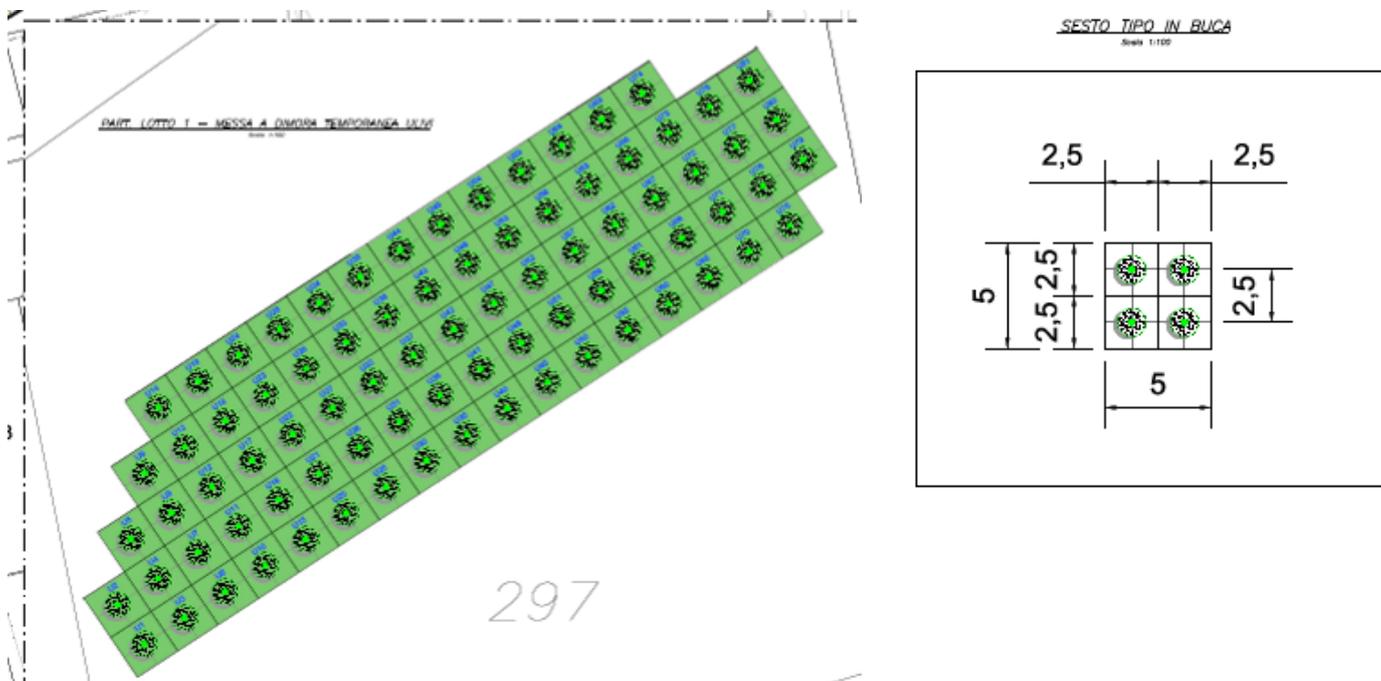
Schema di impianto degli ulivi trapiantati Lotto 1
